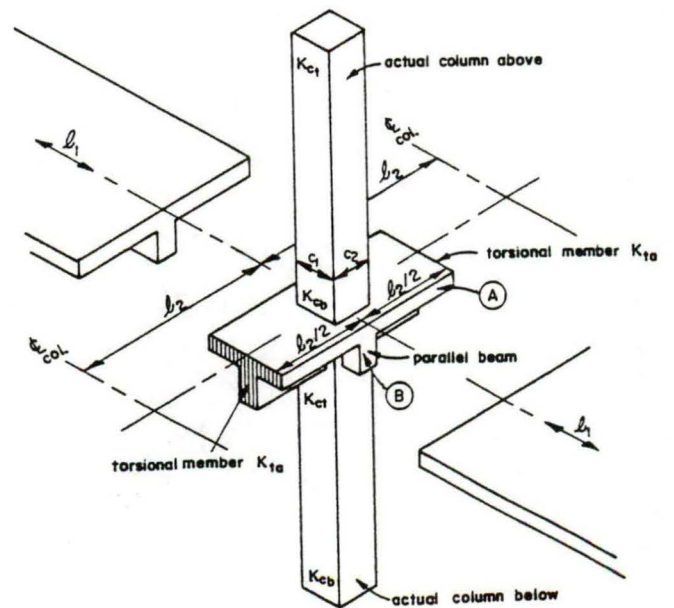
Fig. C. Columna equivalente (columnas más elementos sujetos a torsión).
